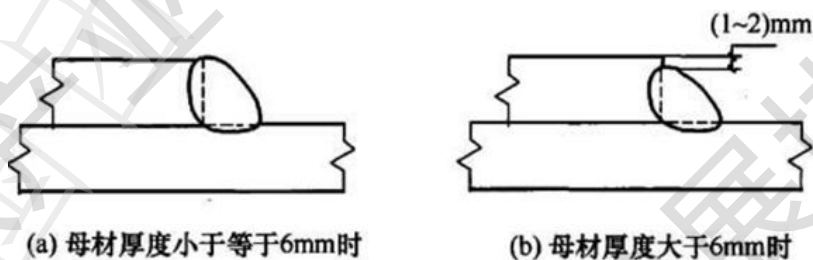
搭接焊缝沿母材棱边的最大焊脚尺寸
